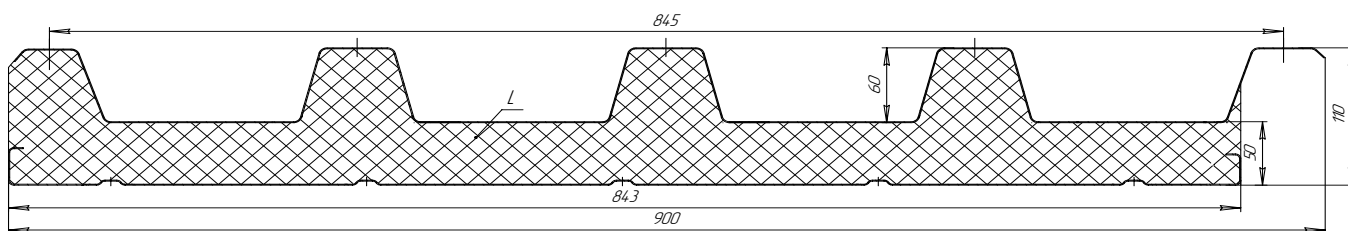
Панель трехслойная кровельная с монтажной шириной 845 мм
